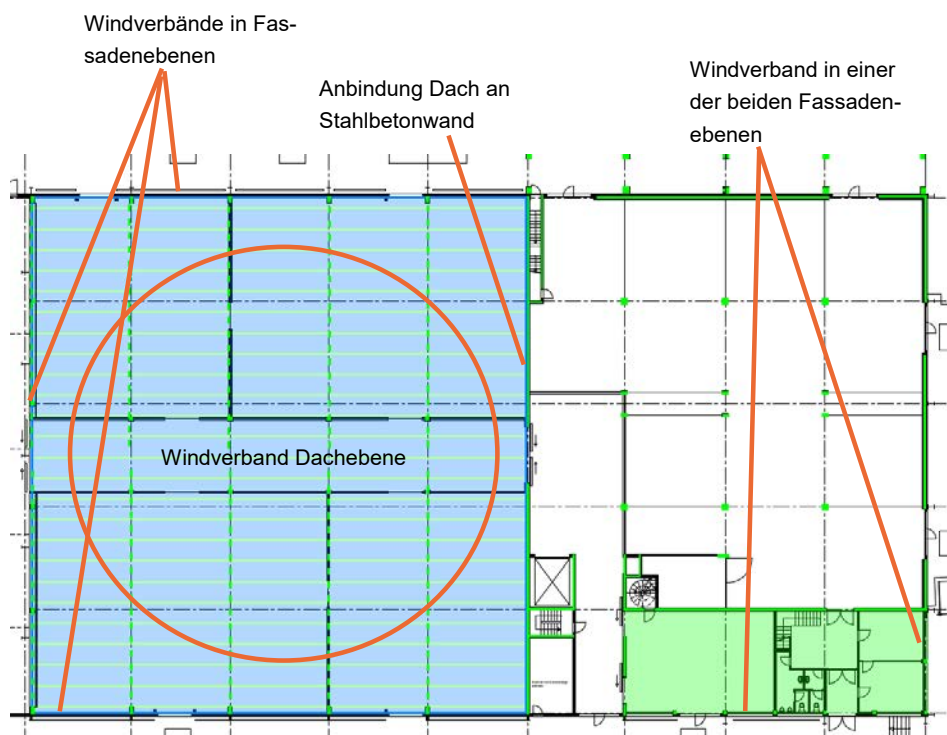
Grundriss EG Kartoffelzentrum: mögliche Massnahmen am Tragwerk
